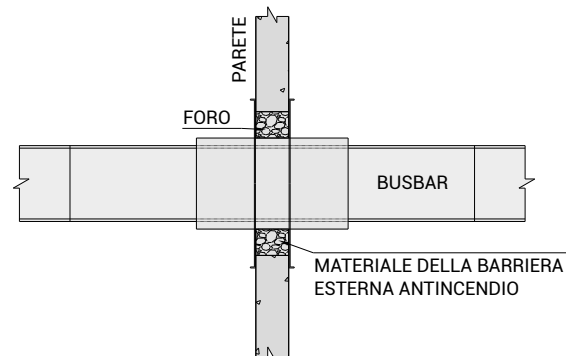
POSIZIONE VERTICALE PER PASSAGGIO DI TRAVE
